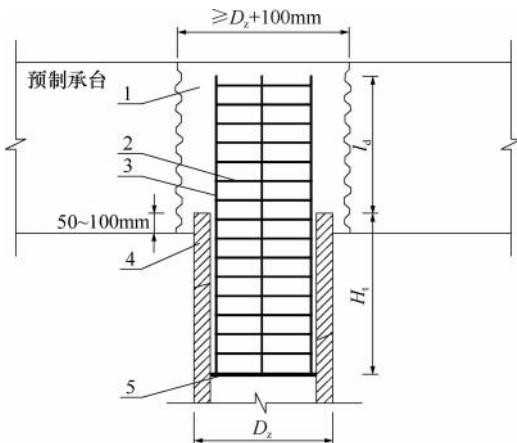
承压混凝土空心桩、钢管混凝土管桩与承台连接
